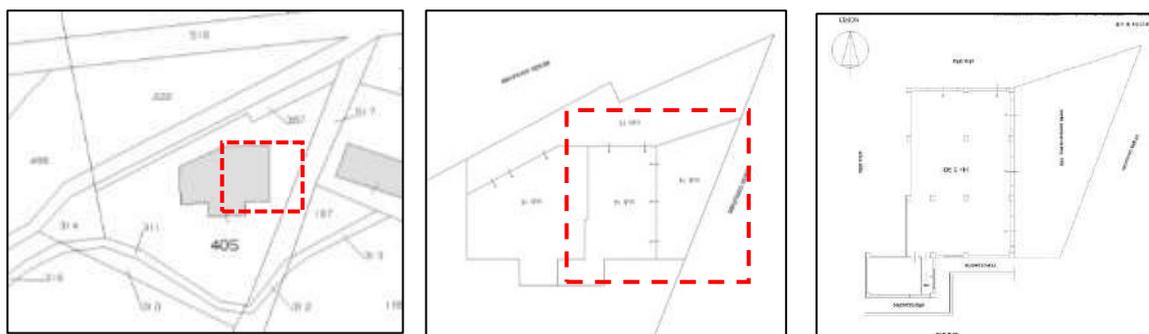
a) Estratto dal foglio di mappa b) estratto da Elaborato Planimetrico c) visura planimetrica immobile
